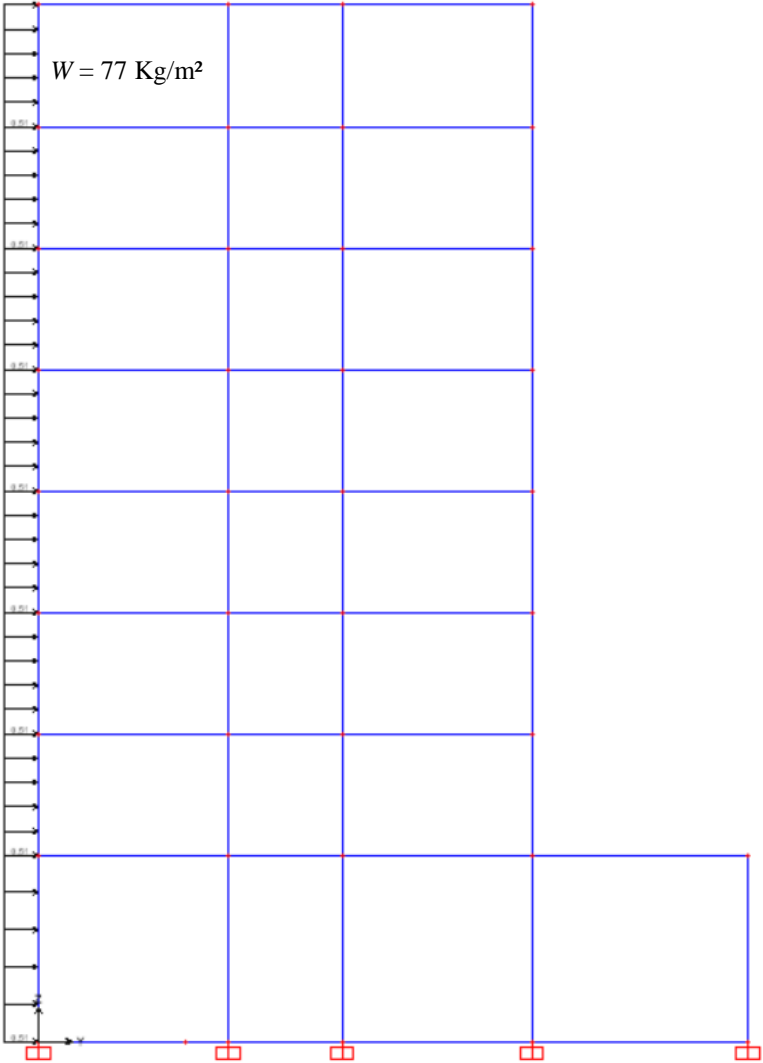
Potongan Melintang Struktur Bangunan
